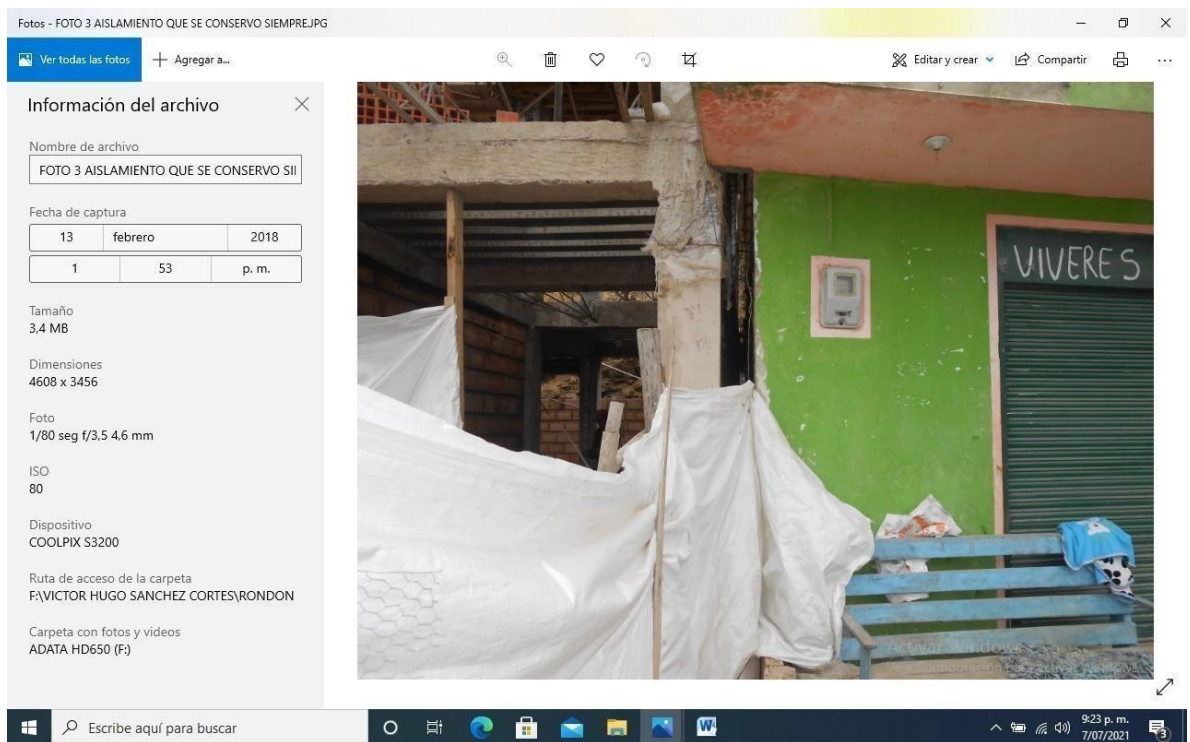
Aislamiento que se conservó, deprimido de 20 centímetros ancho, que separa las dos propiedades y balcón segundo piso que sobrepasa edificación costado occidental
